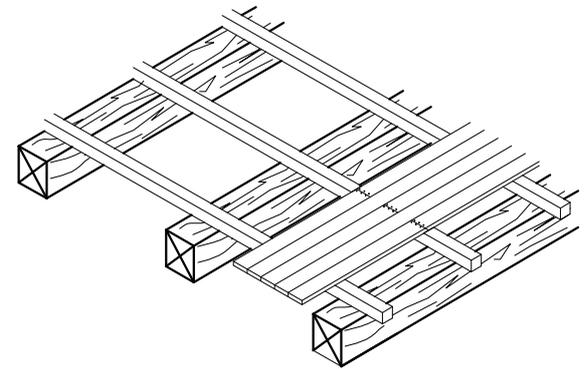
VIGAS - TIRAS - DUELAS DE MADERA
